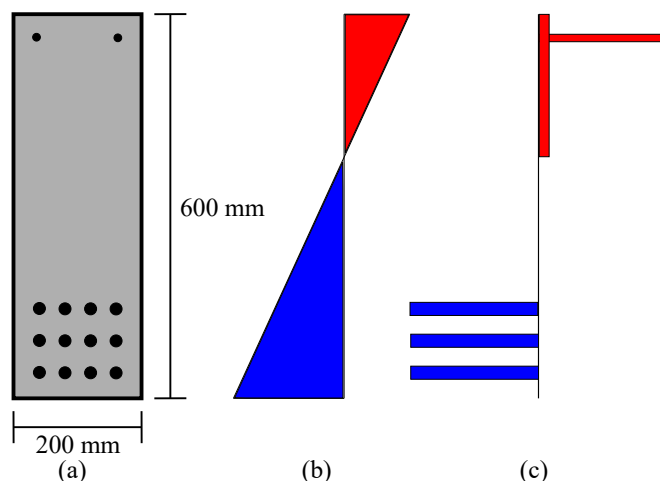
Seção de concreto armado da viga bi-apoiada: (a) Detalhamento; (b) Deformações; (c) Tensões
